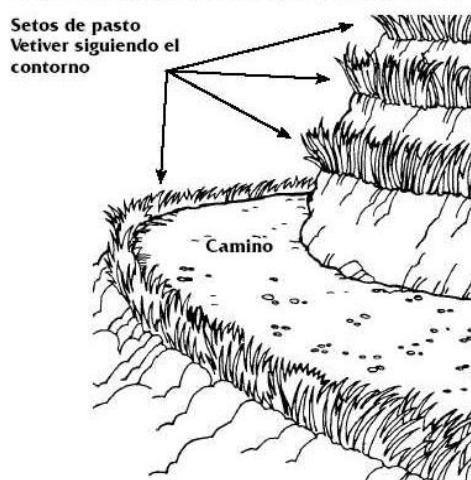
Re-vegetación de taludes, siguiendo la forma de las laderas
